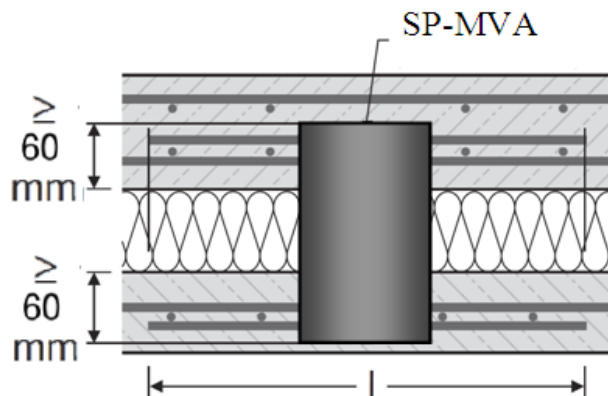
Détails de l'enrobage des armatures (disposition d'un cylindre)
